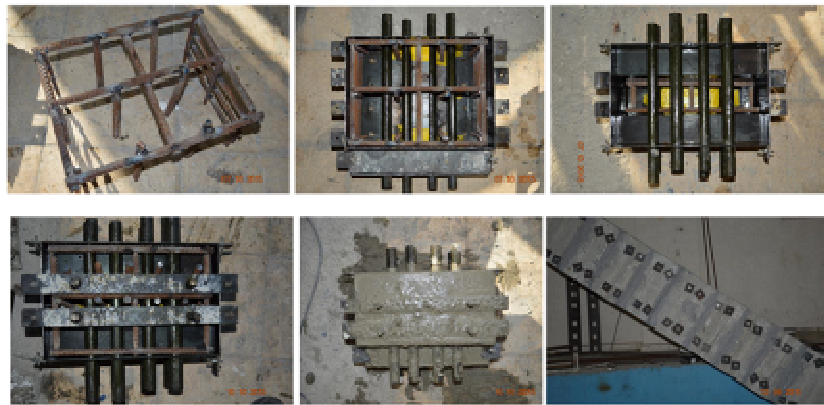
5. BEÇÇ\_3 eleman yapım detayı
